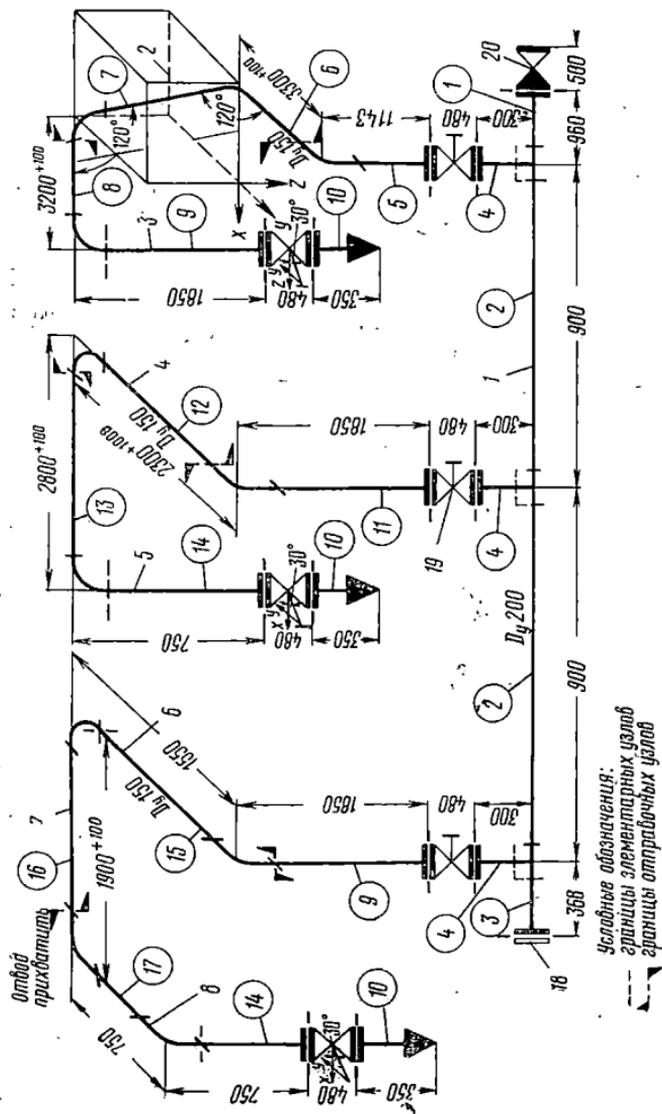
Заготовительный чертеж для изготовления трубных узлов
